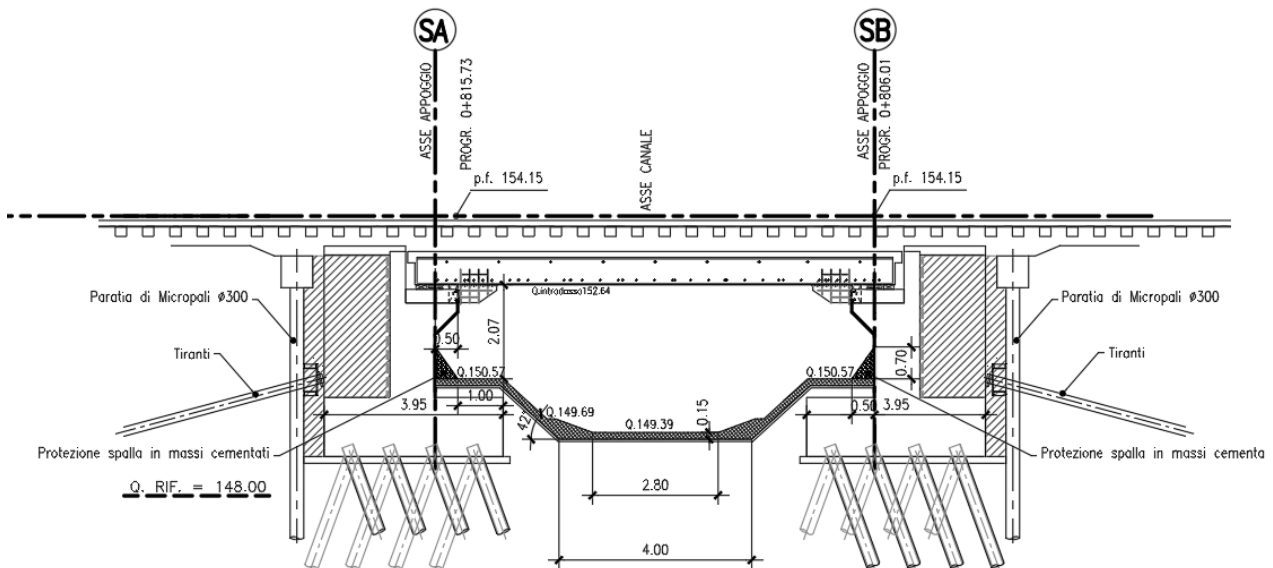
SEZIONE DI PROGETTO DEL VI05
